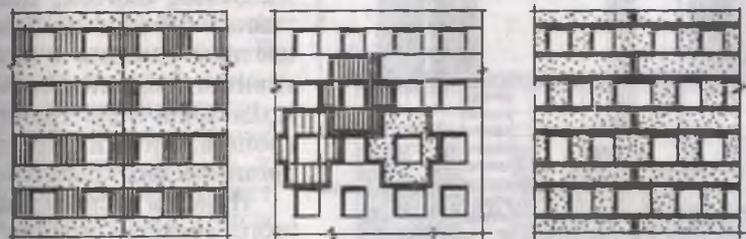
Характерные схемы фасадов с несущими наружными стенами (а) и примеры разрезок несущих стен на панели (б)
